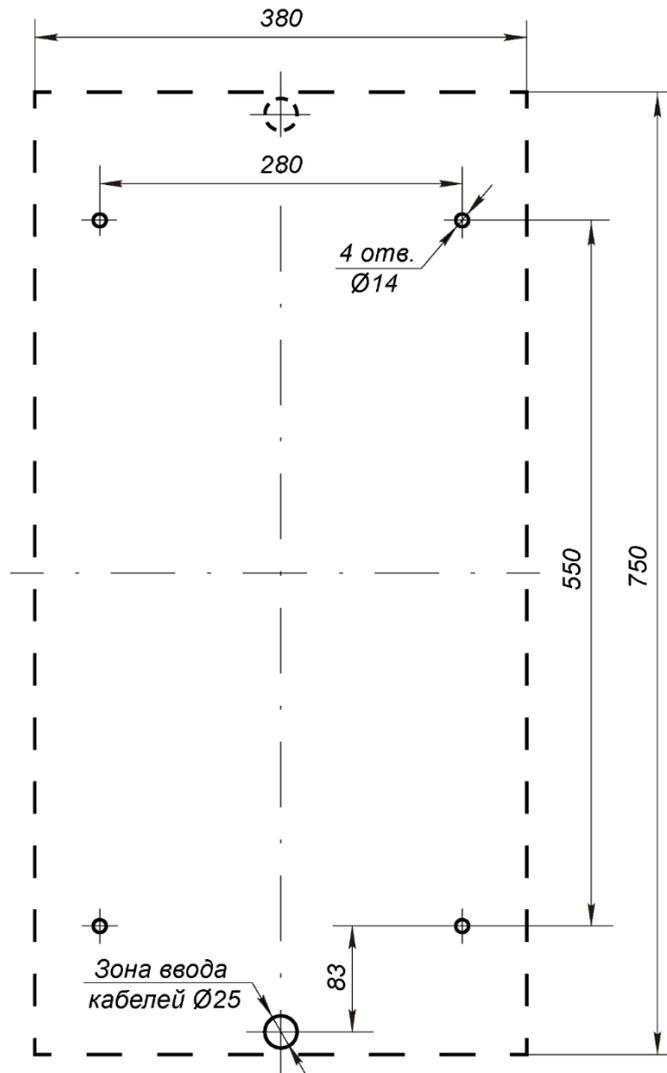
Схема разметки для монтажа кронштейна-подвеса шкафа на стене
